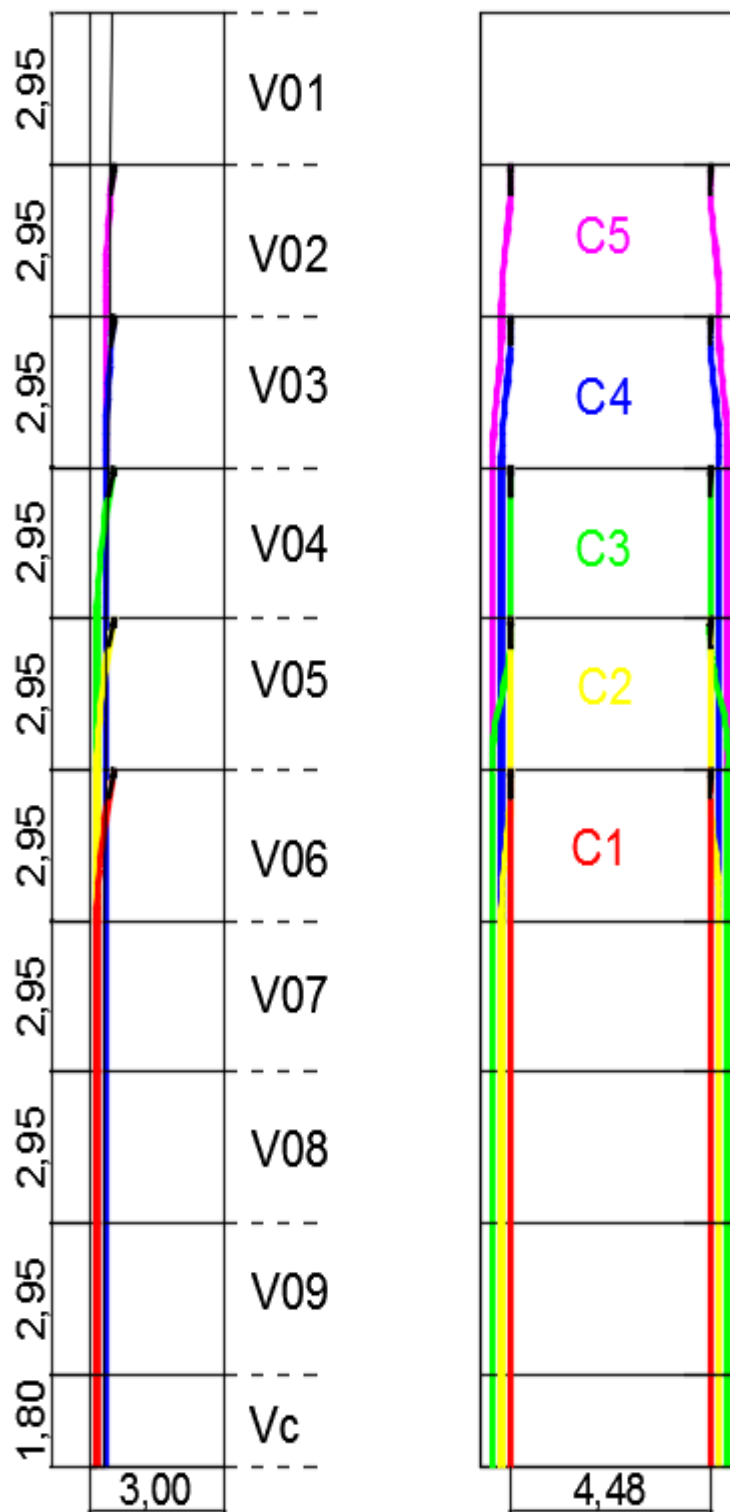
Tracé en élévation et en plan des câbles de continuité de travée principale.
